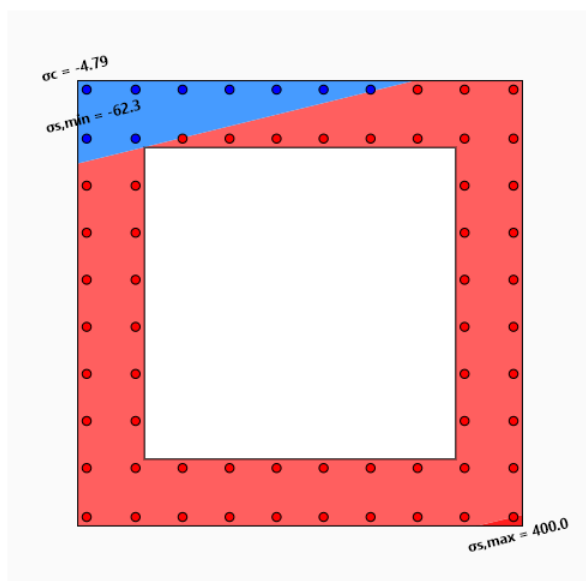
Vierkante koker doorsnede — geometrie en wapeningsindeling.
